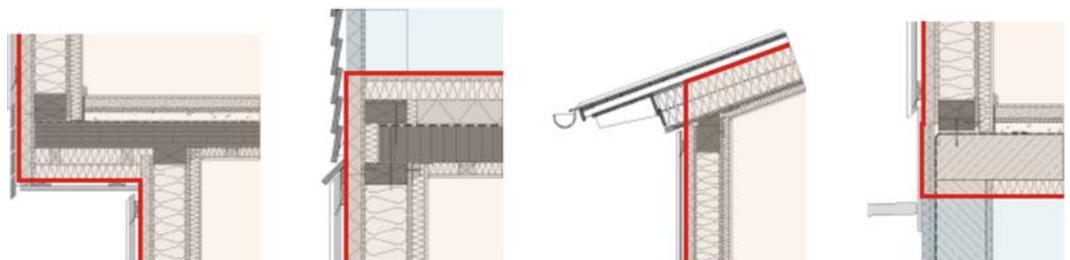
Ermittlung des konditionierten Bruttovolumens, Lage der thermischen Gebäudehülle im Schnitt: Außendecke (ganz links), Decke zu unkonditioniertem Dachraum (mittig links), Steildachanschluss (mittig rechts), Decke zu unbeheiztem Kellerraum (ganz rechts). (Quelle der Details: [Holzforschung Austria, 2009])
